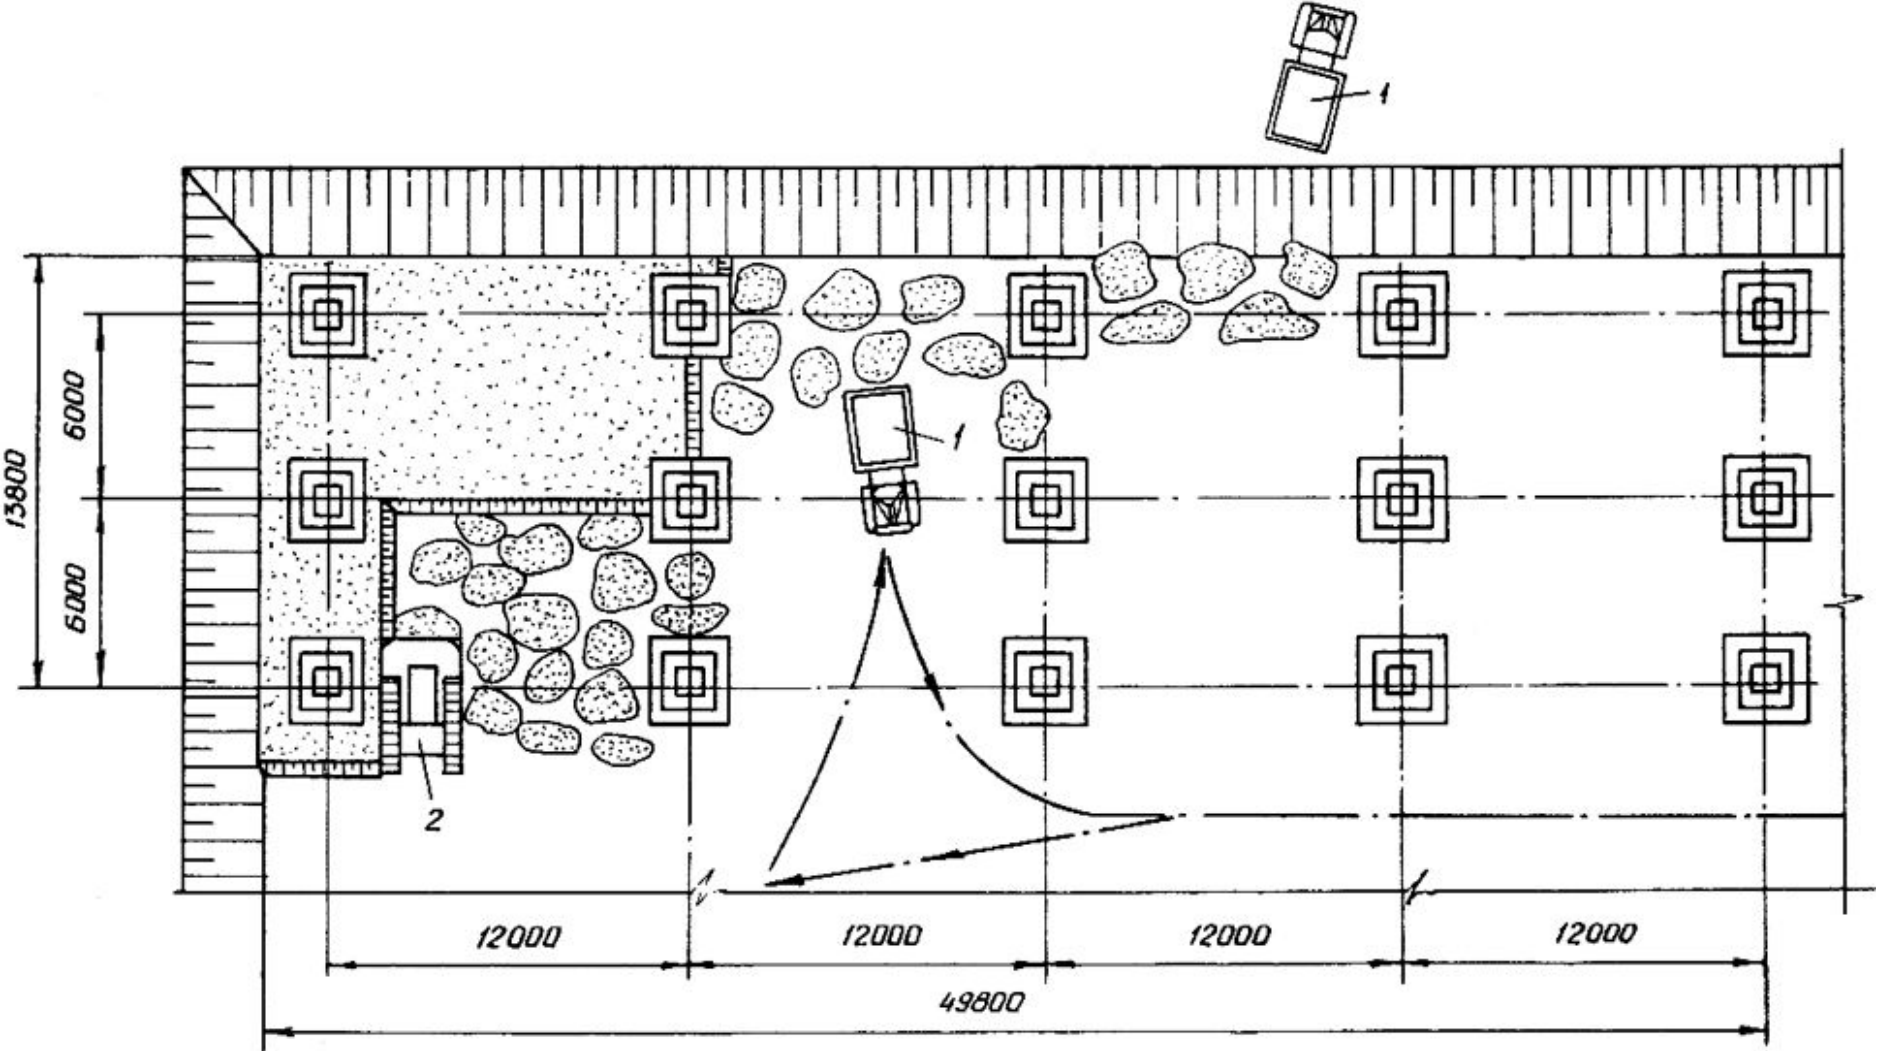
Обратная засыпка, разравнивание и уплотнение грунта внутри зданий под полы:
